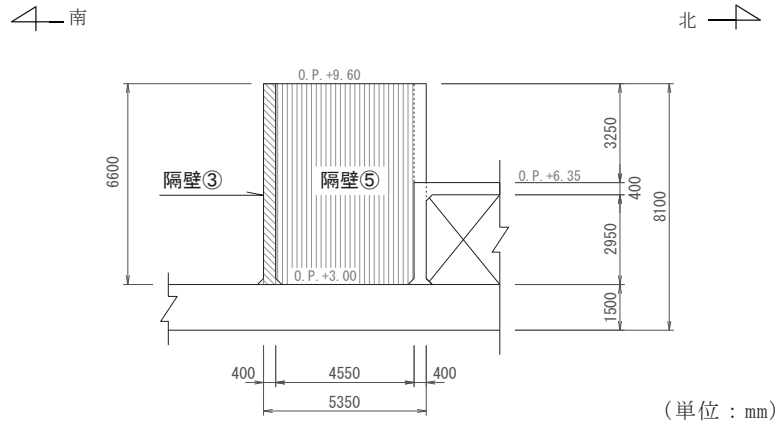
(5) 補機ポンプエリア断面図 (⑤—⑤断面)
